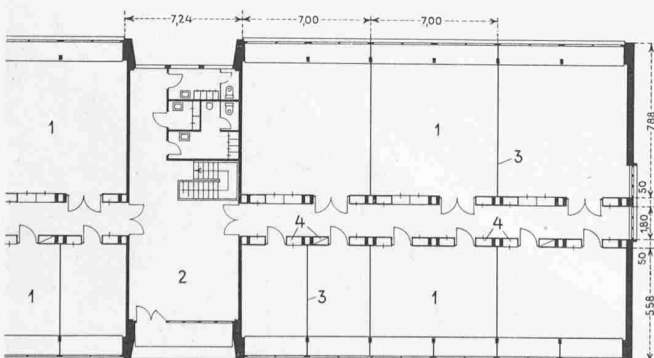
Laboratorien, Teilgrundriss 1:400. 1 Laboratorien; 2 Aufenthalts- und Diskussionsplatz; 3 Versetzbare Wände in Holz; 4 Schächte für Ventilation, elektrische und sanitäre Installationen
